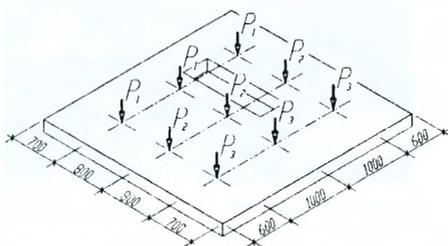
Схема эквивалентных нагрузок на плиту МП – 4Б
